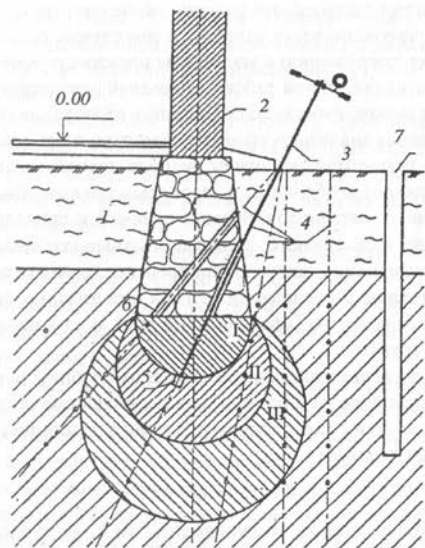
Зондирование лопастным зондом грунтов в основании фундамента (по В.М. Улицкому и др., 2002):
